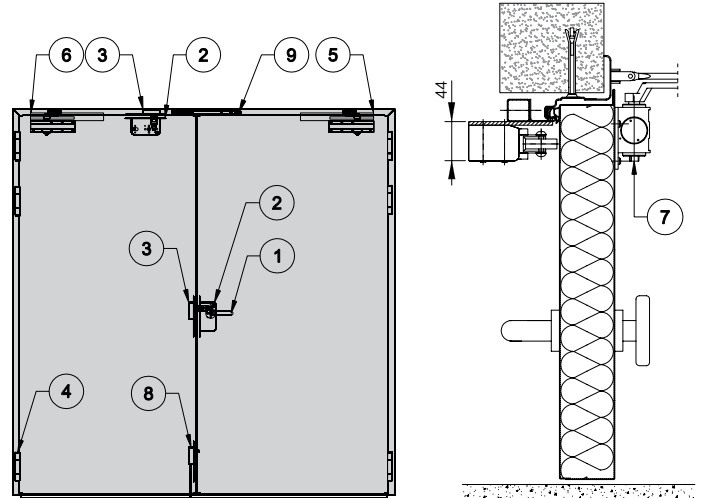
Schema zweiflügeliger Türen – Vertikalschnitt mit Belüftungssystem
